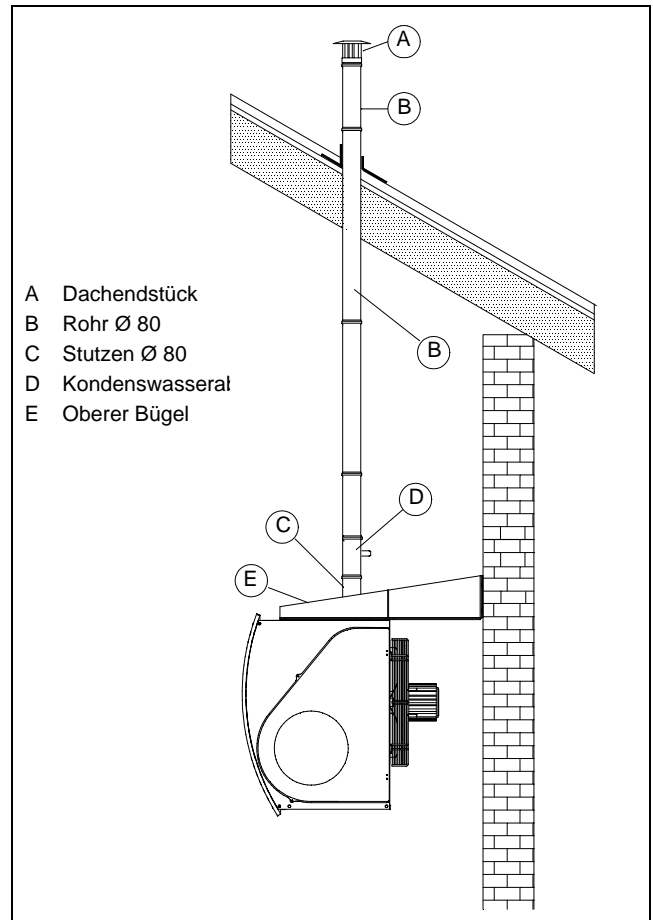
INSTALLATION TYP B23 MIT RAUCHABLEITUNG ÜBER DACH
